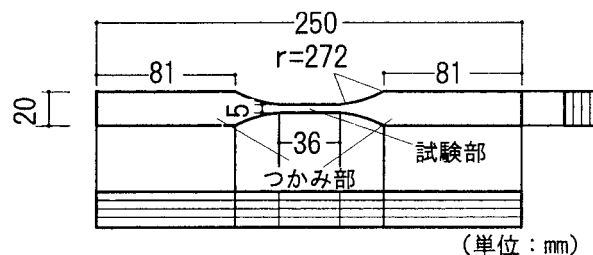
竹ラミナ集成材引張試験 試験体形状・寸法
